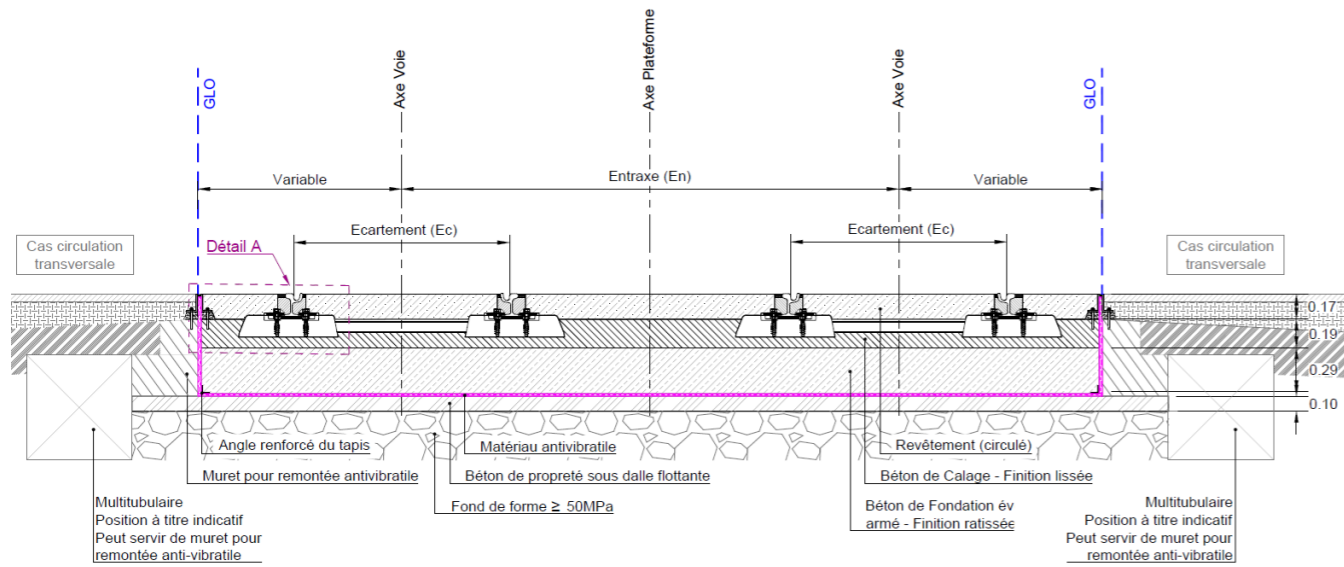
coupe type d'une plateforme - Voie béton traverses – Dalle flottante
